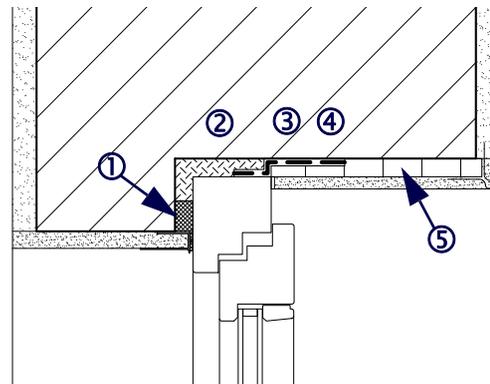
Detail einer Fensterleibung mit den notwendigen Anschlussmitteln.
